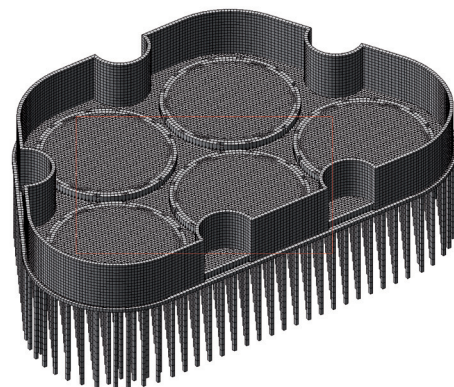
Общий вид монолитной железобетонной чаши и фундамента
